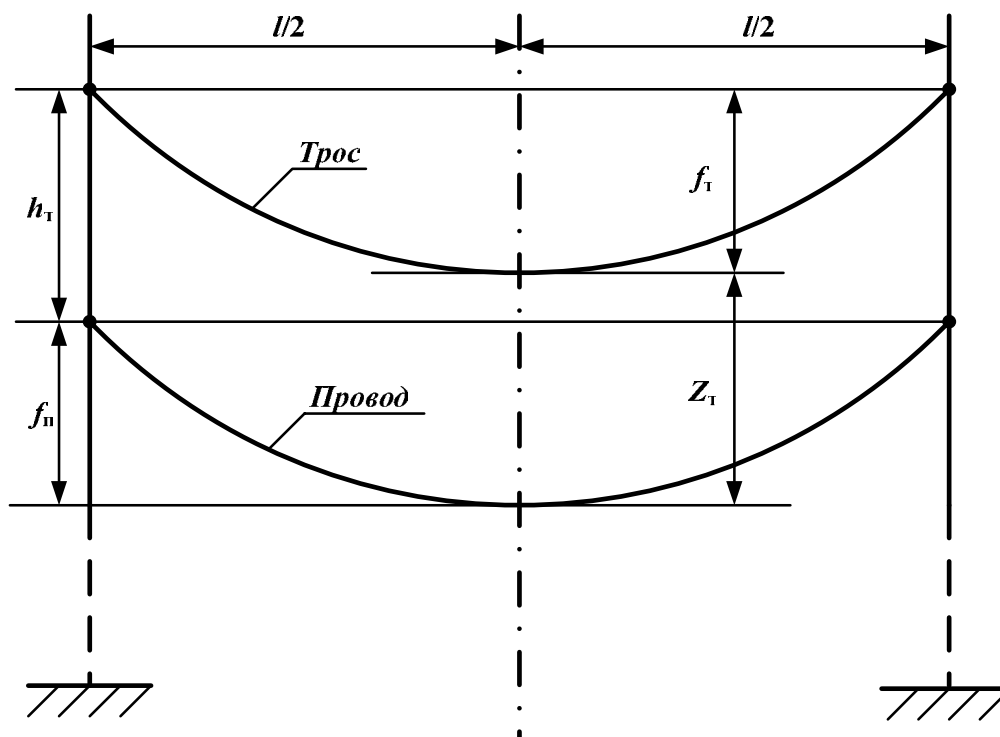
Схема подвеса провода и грозозащитного троса на опоре
